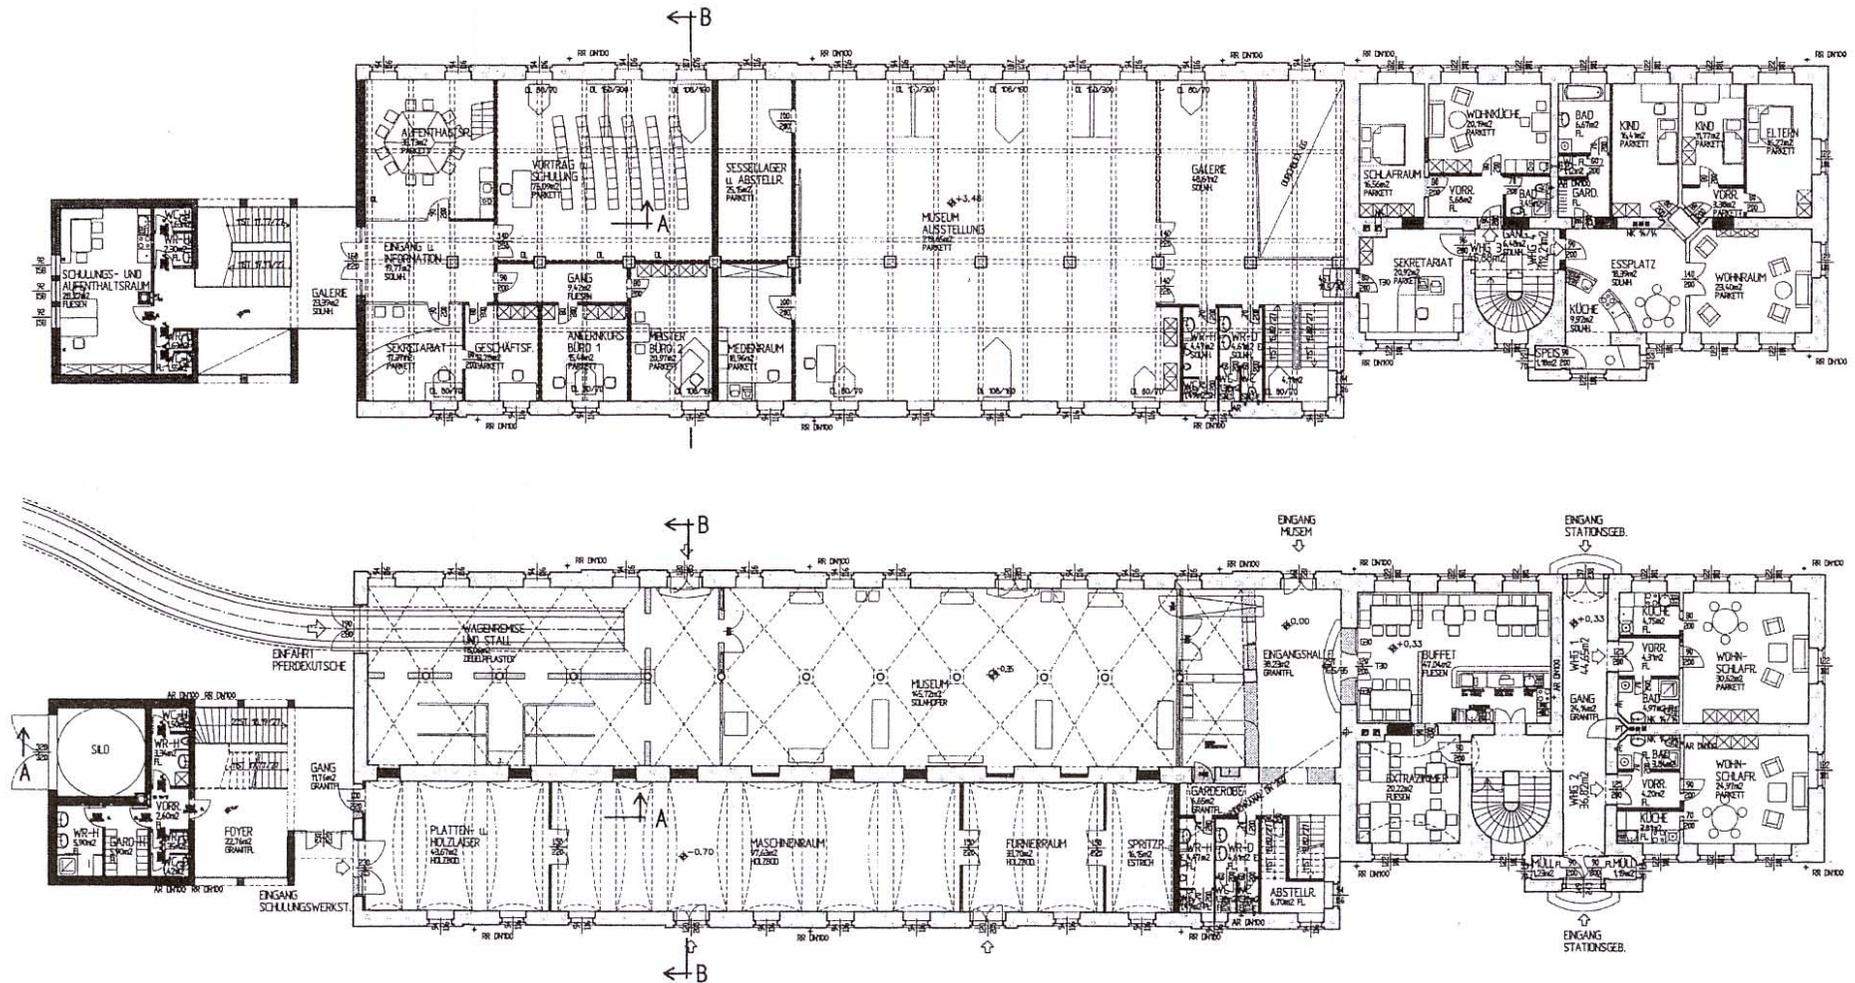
Grundrisse des zum Pferdeisenbahnmuseum umgebauten Stationsplatz Kerschbaum.
